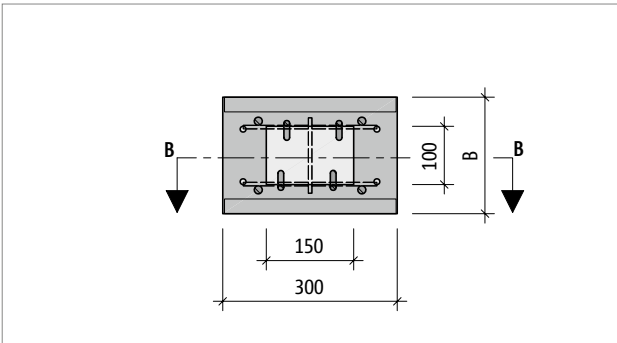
Schöck Sconnex® Typ W-NT1T1-V1H1: Produktgrundriss; Drucklagerfläche 150 × 100 mm
